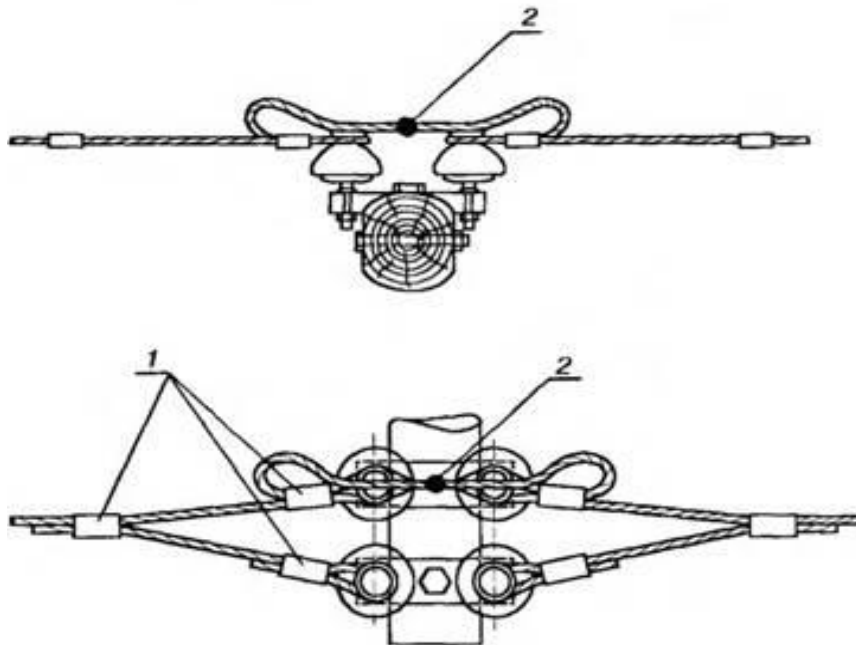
Одинарное усиленное угловое крепление провода на штыревых изоляторах угловой опоры:
